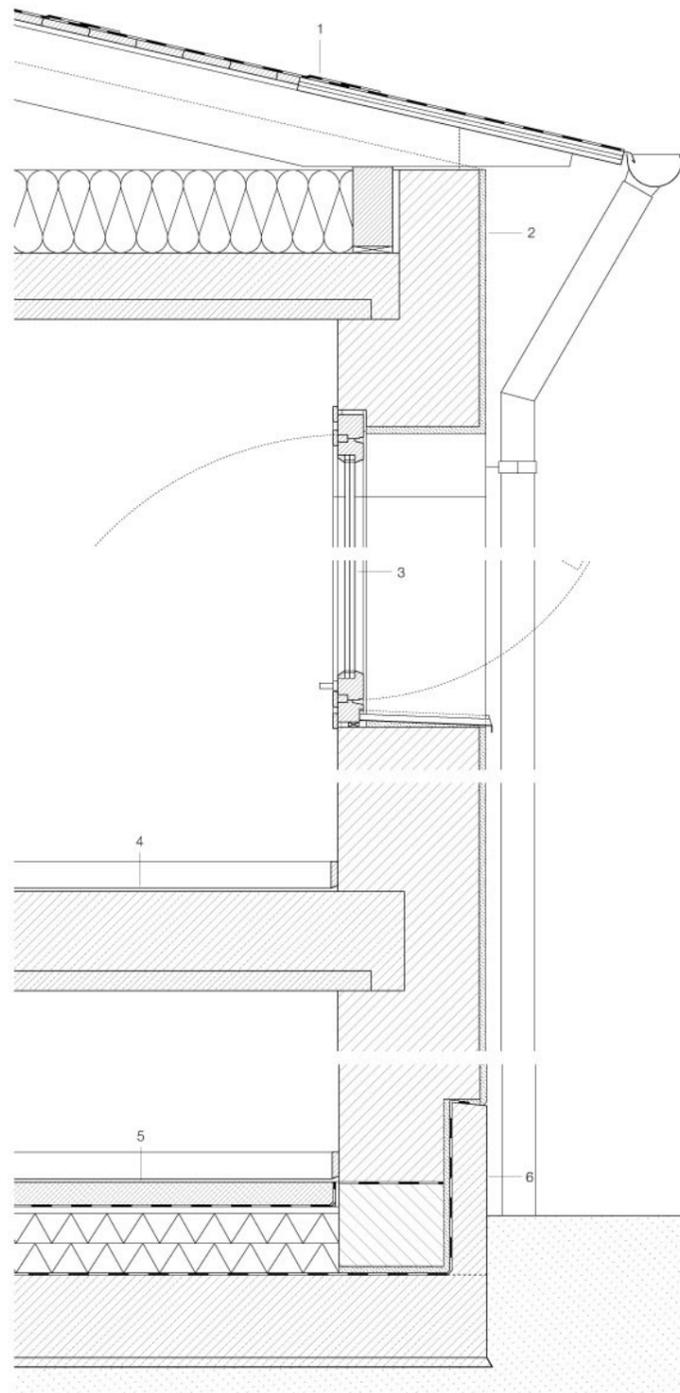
Fassadenschnitt Gebäude Mauerwerk:
